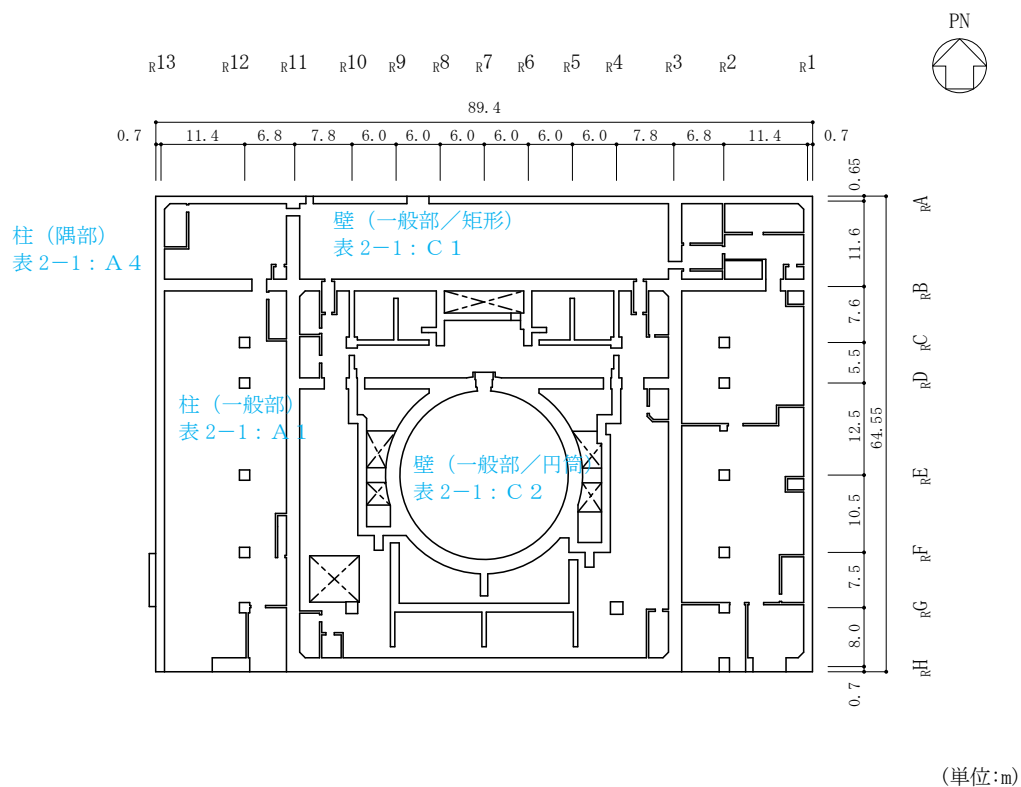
(4) 原子炉建物の概略平面図 (EL 23.8m)
